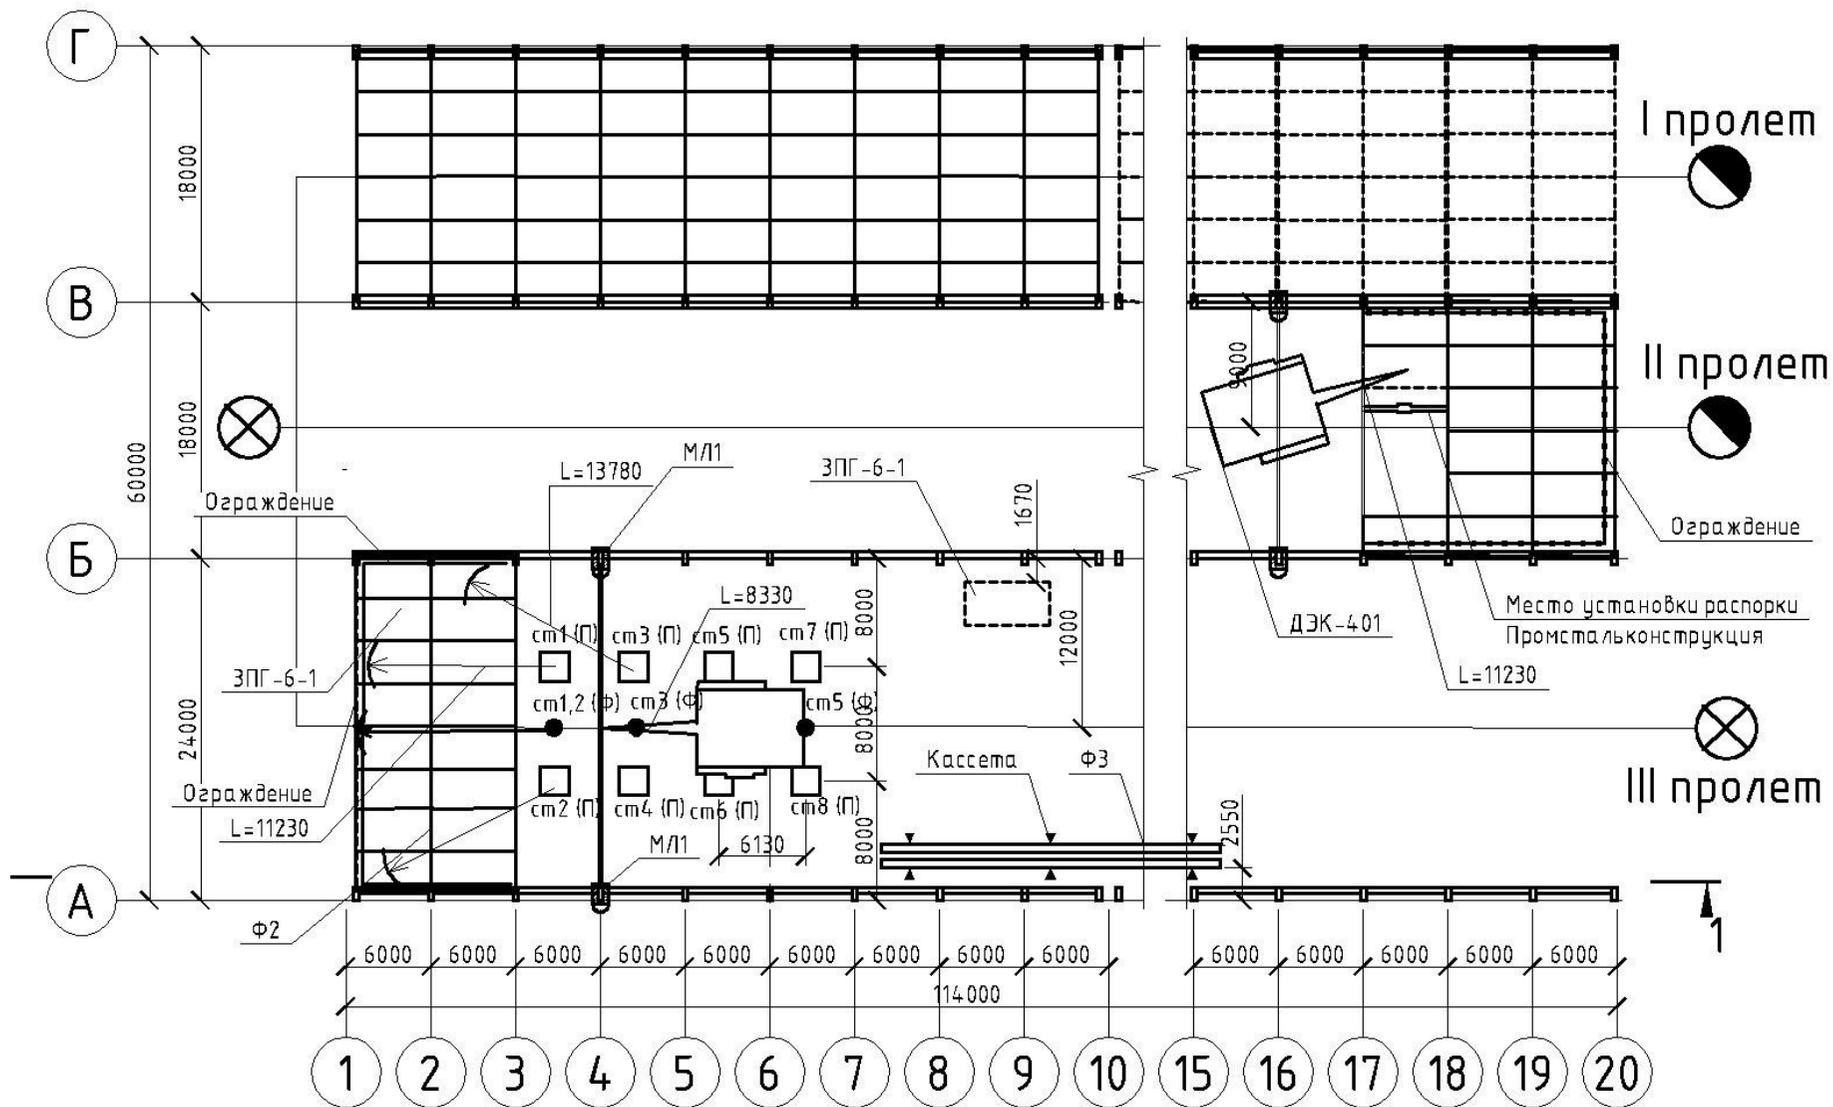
Общая схема монтажа элементов покрытия (стропильных ферм и плит) каркаса первой очереди строительства в пролетах А-Р (5-15) комплектом монтажных кранов, выполнил Наумов Р.С. гр. ТСНК-
